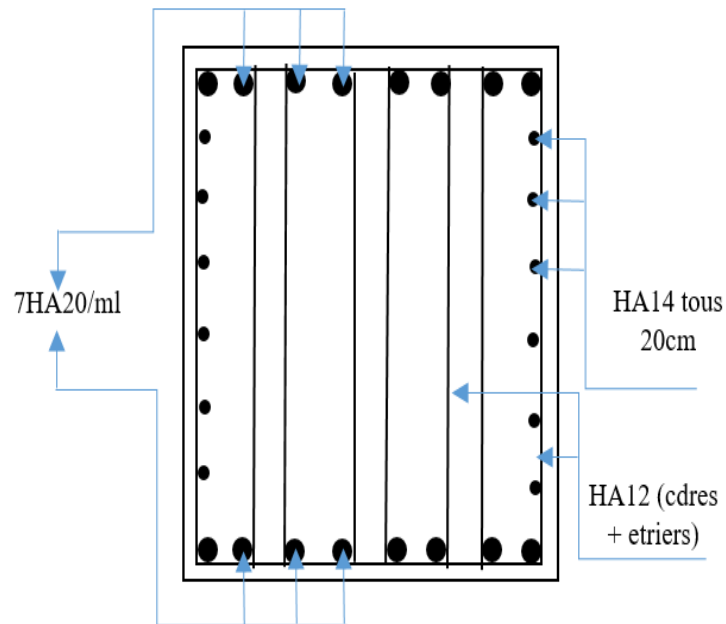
FERRAILLAGE DE LA POUTRE
